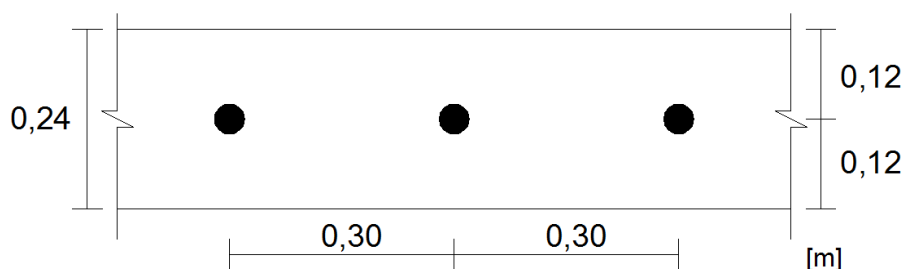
Corte longitudinal das armaduras de pré-esforço transversal (Marques, J. 2013)
